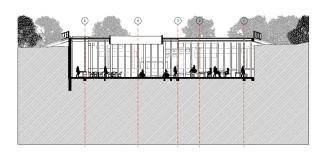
,9. Planta urbana, Corte arquitectónica Fuente: Elaboración propia U.C de C. Grupo2. (2017).
